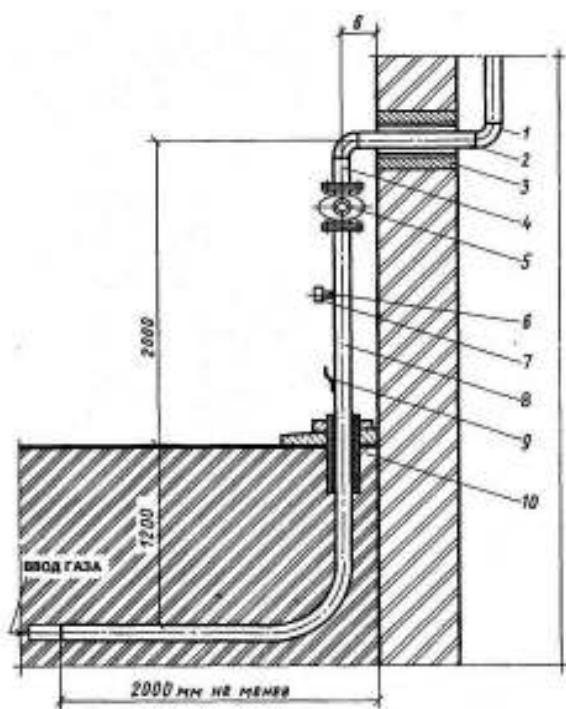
Цокольный ввод газопровода природного газа с изолирующим фланцевым соединением: 1 - отвод 90° dn 57x3 мм; 2 - труба; 3 - прокладка газопровода в футляре через стену; 4 - патрубок; 5 - кран du=50; 6 - штуцер; 7 - колпак du=25; 8 - труба; 9 - пластина; 10 - прокладка газопровода в футляре.
